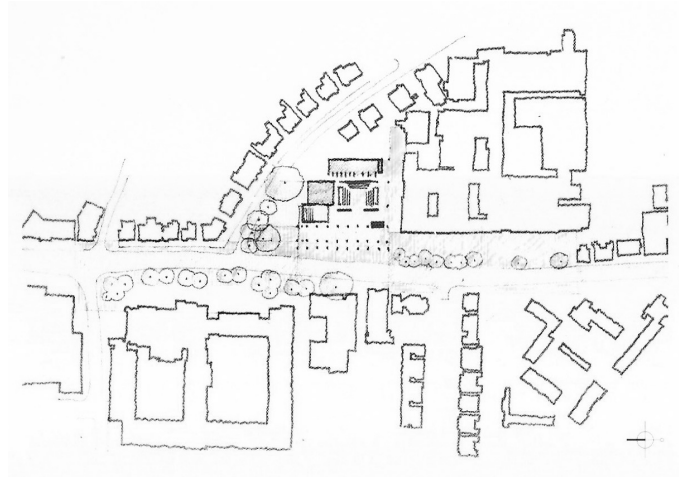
Boceto en planta del Town House de la Universidad de Kingston.
